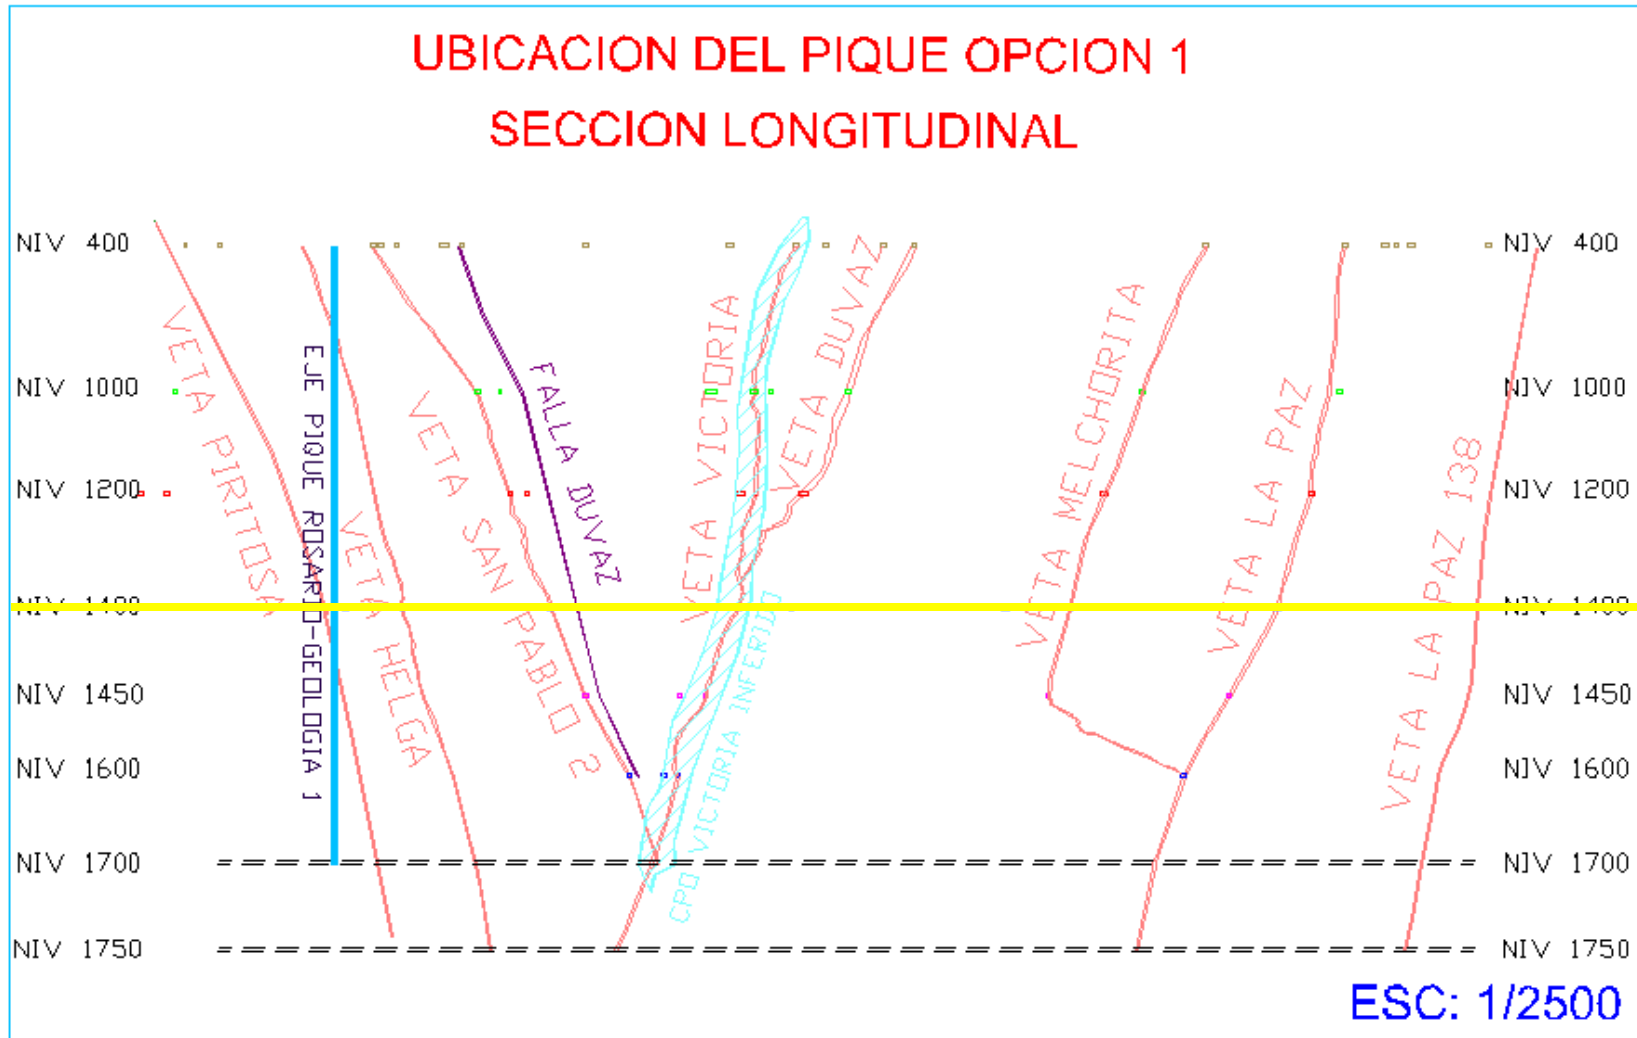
Plano de Ubicación de Pique Central – Opción 1
